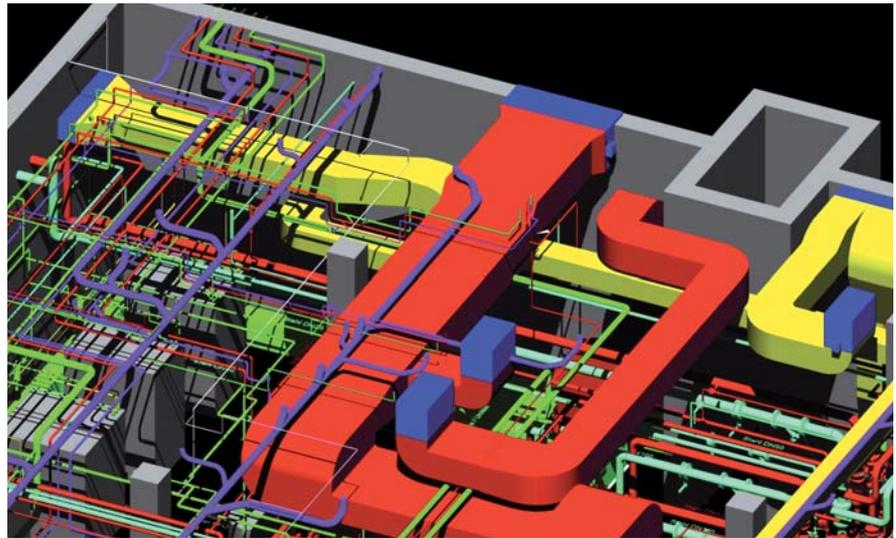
Technik-Zentrale, eingebettet in den Grundriss. Der Plan ist Basis für die Planung der Aussparungen (Bild: Planungsbüro für Haustechnik Manfred Süß, Pfreimd)
